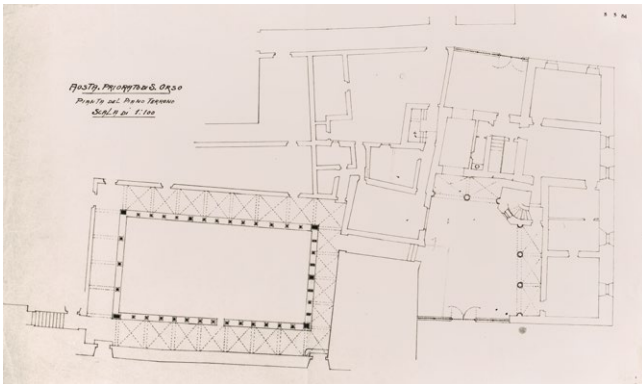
[C. BERTEA], Aosta. Priorato di Sant'Orso. Pianta del piano terreno, scala di 1:100 (SABAPTo, Archivio d'Andrade, cartella 3/3/123, Aosta, Priorato di S. Orso, n. 3/3/84, ©SABAPTo tutti i diritti riservati).
